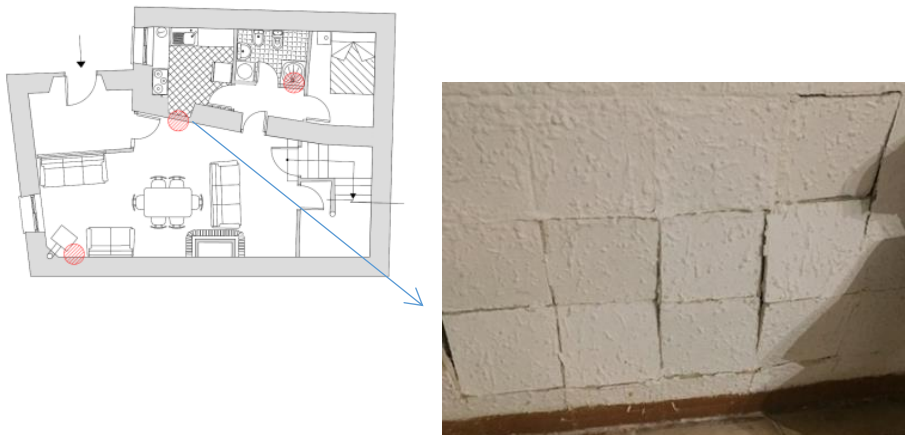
Azulejos sueltos en la pared del comedor en planta baja. 2017. Fuente: Autor.
